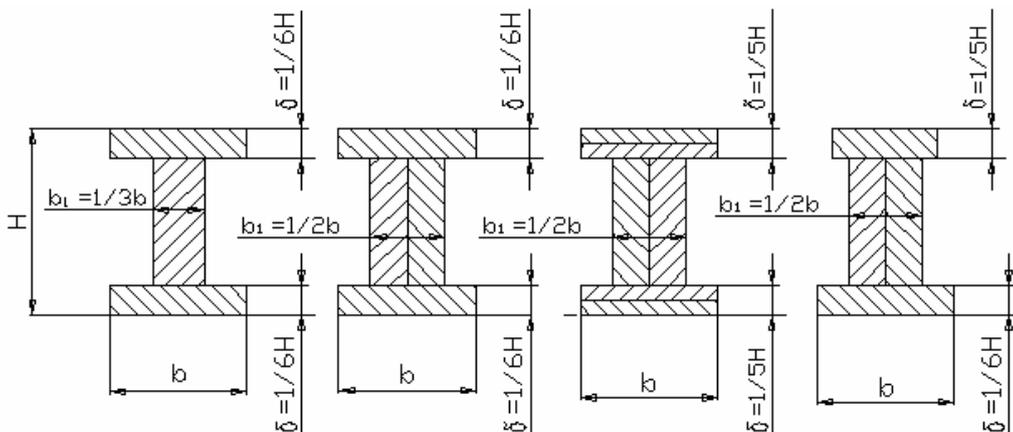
Типы поперечных сечений клееных балок для перекрытий
